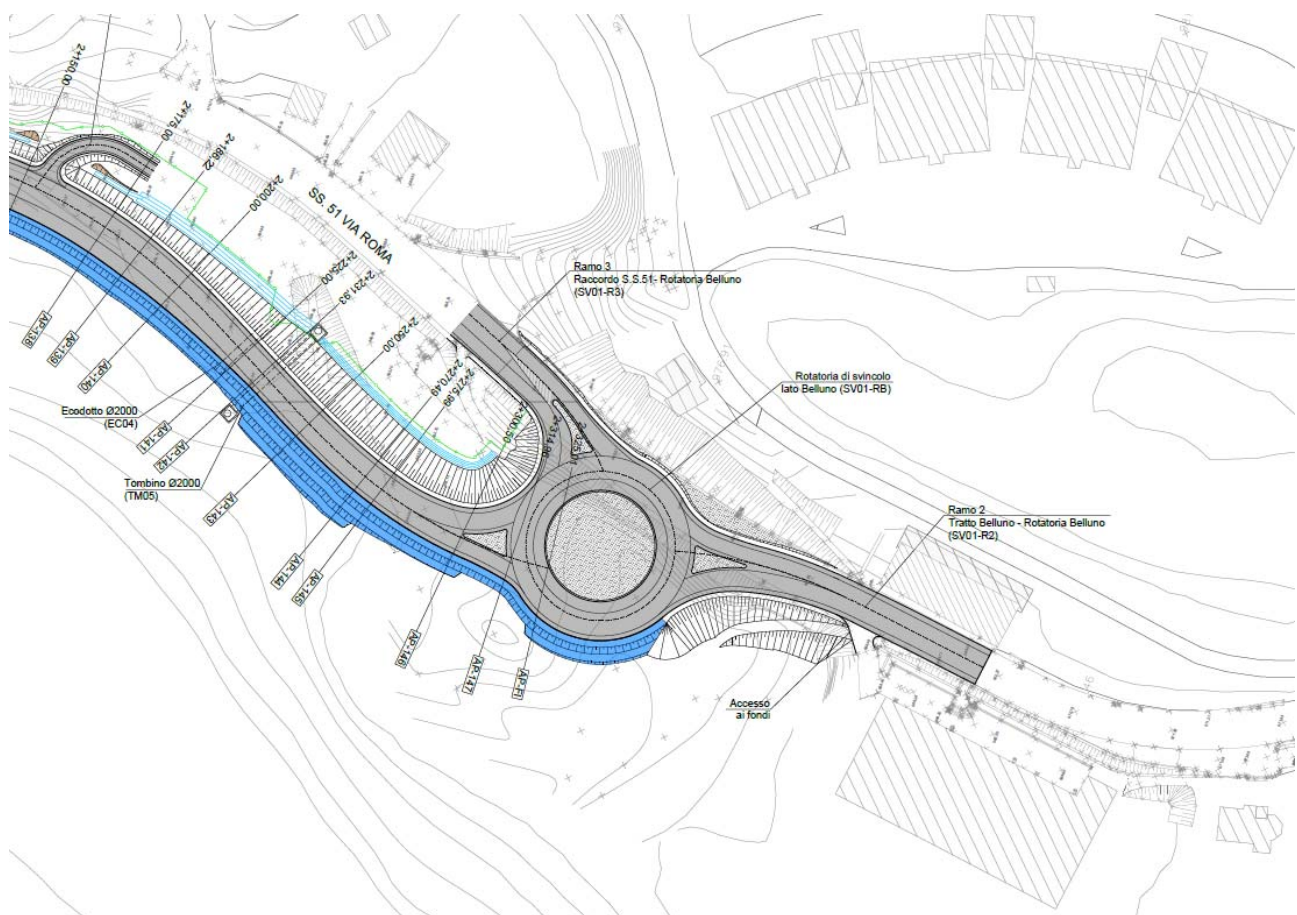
Stralcio planimetrico rotatoria di Svincolo lato Belluno
